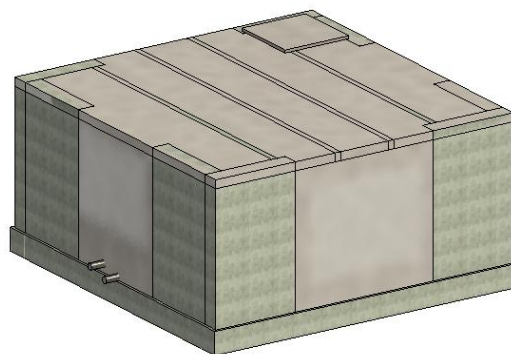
Vista en planta desarenador del sistema Alto del Rayo.
